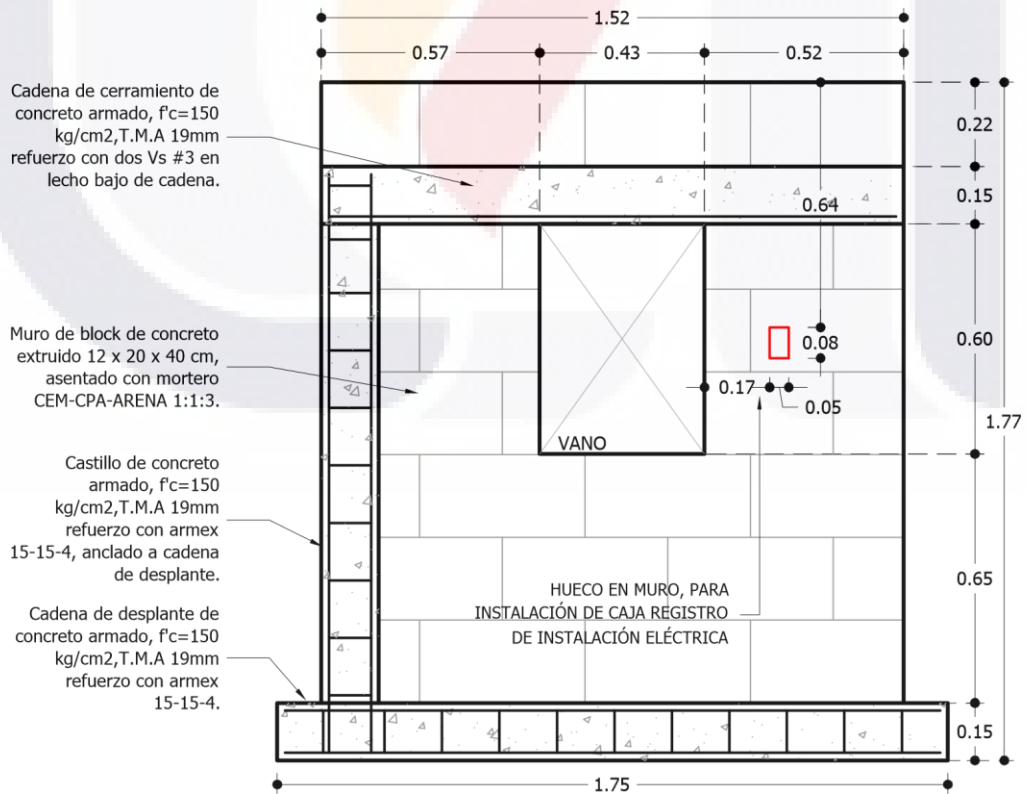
Detalle constructivo de diseño de MBC 1 Cara B
